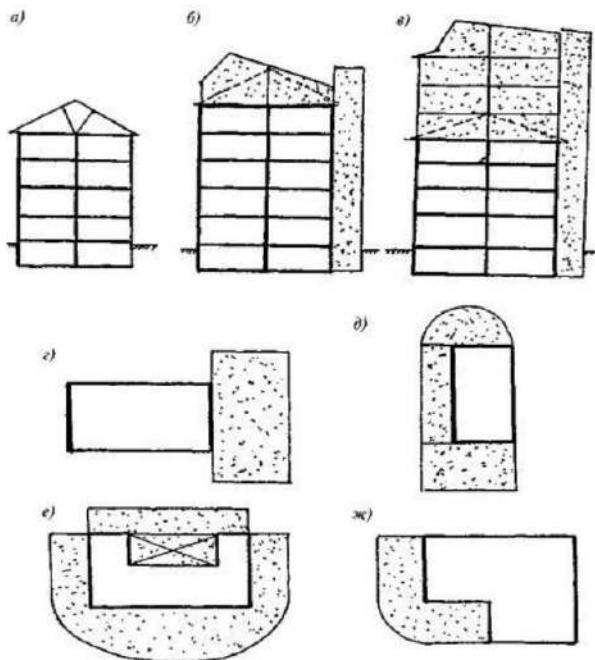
Варианты реконструкции жилых зданий ранней постройки:
